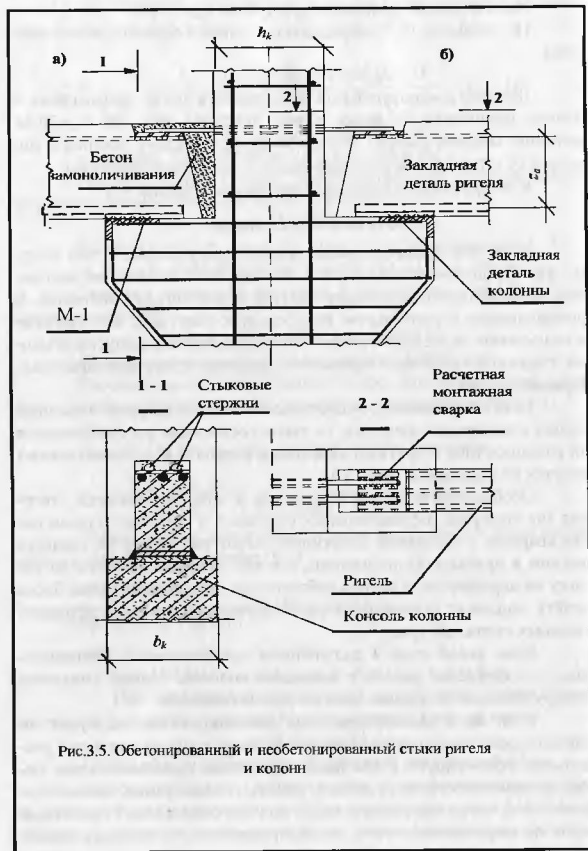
Обетонированный и необетонированный стыки ригеля и колонн
